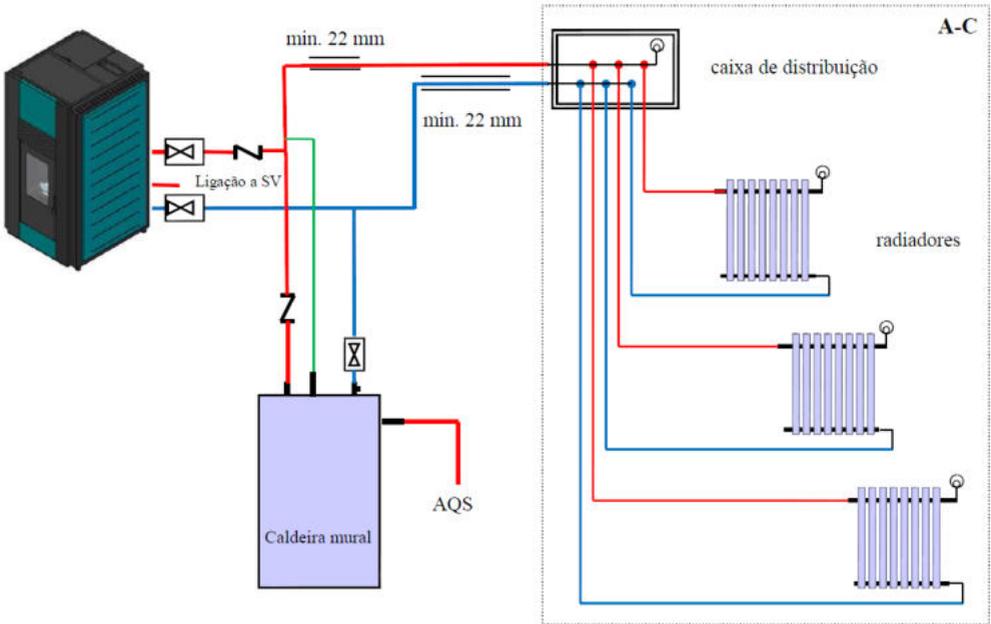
Esquema de instalação para aquecimento central a Pellets com apoio de caldeira mural.
